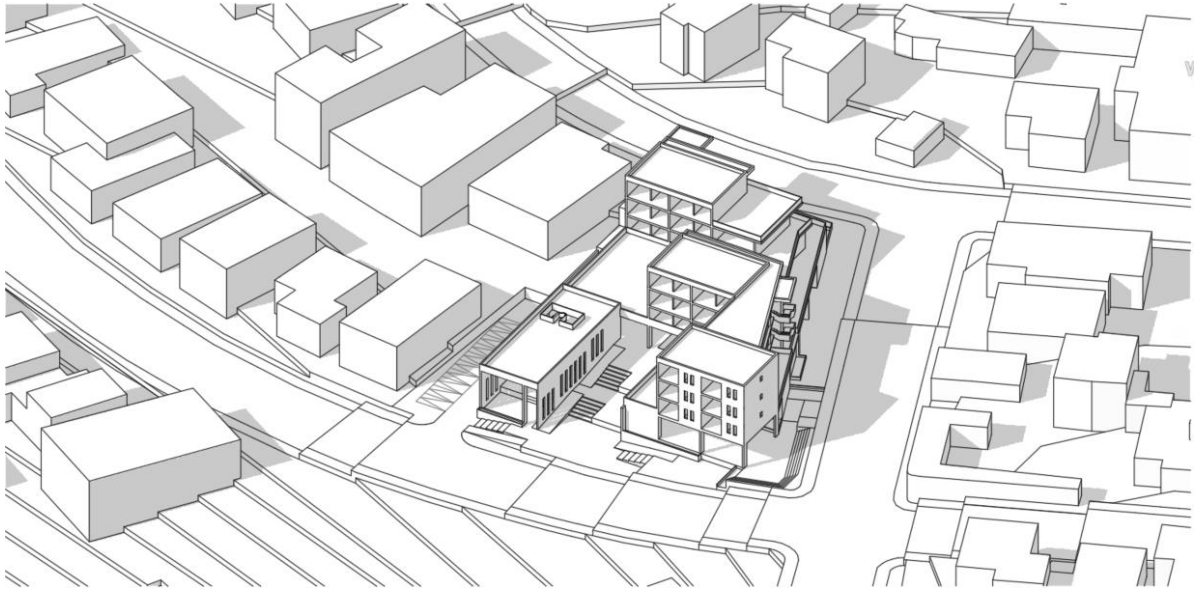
Axonometría noreste - Anteproyecto 02. Elaboración propia.
